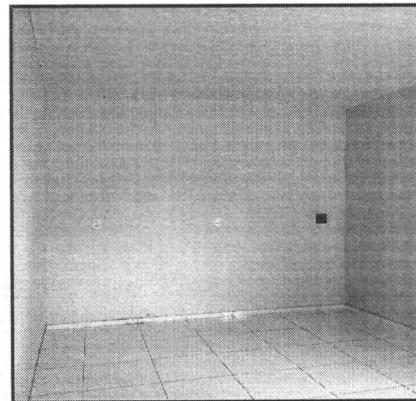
Imagem de Sala, com pintura acrílica, forro em PVC e piso cerâmico
